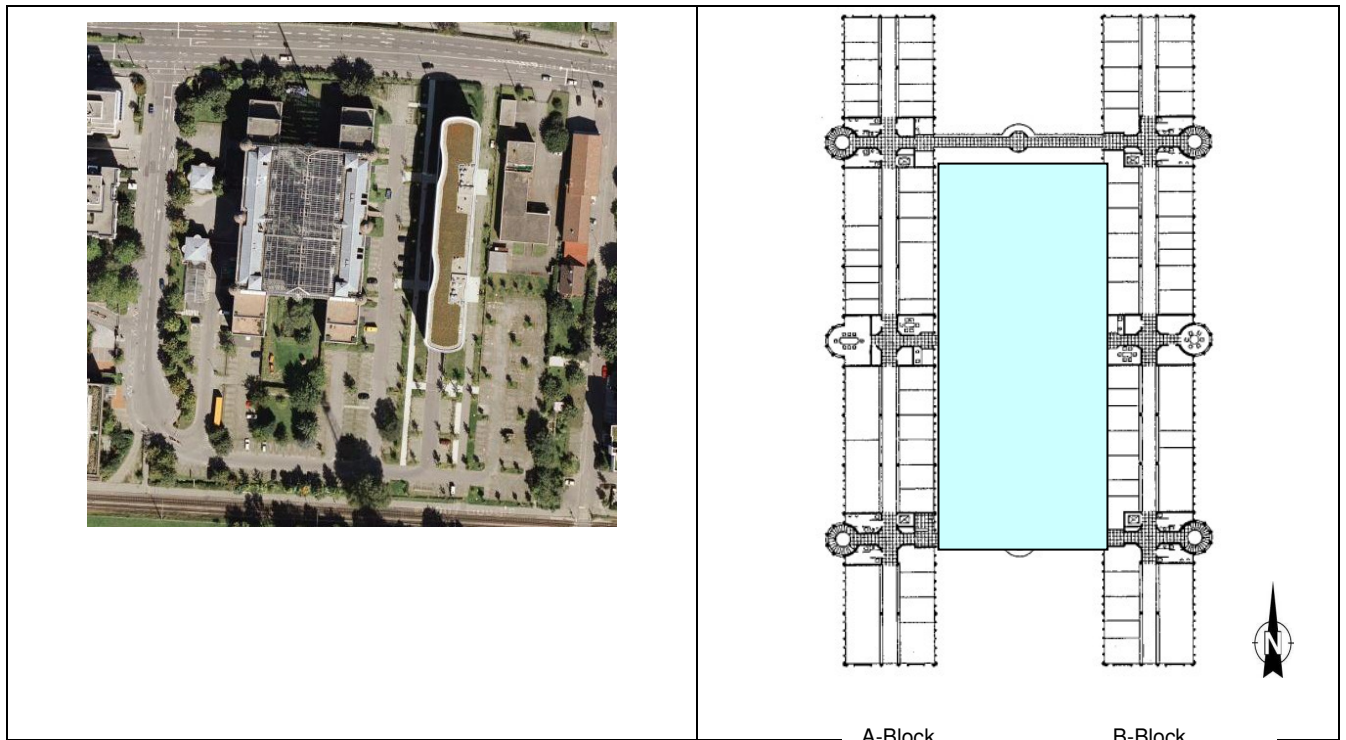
1: Lageplan des Züblinhauses mit Anbindung an die Vaihinger Straße im Norden sowie dem Albstadtweg
